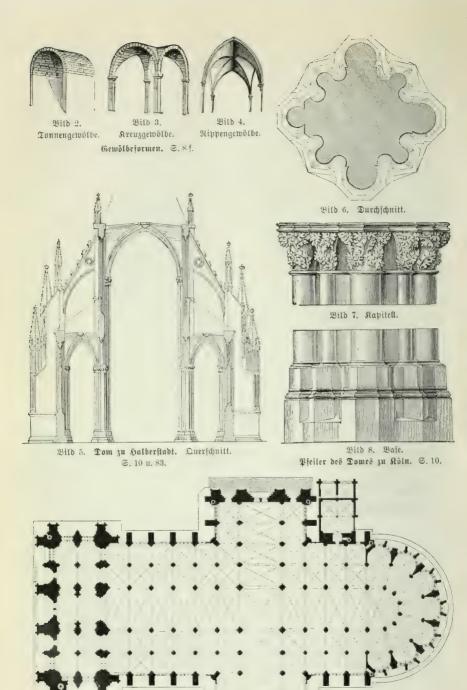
Dom zu Köln. Grundrig. S. 11 u. 78.
